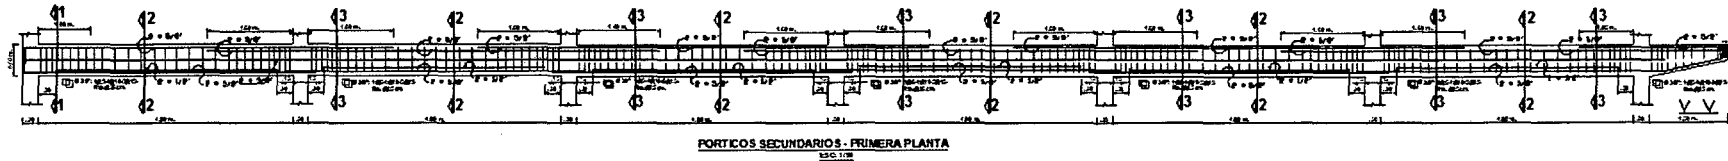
Detalle de vigas secundarias de primer nivel.
